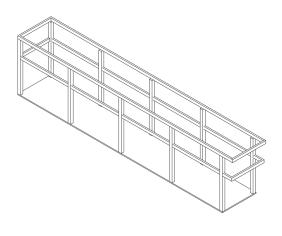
Axonometría estructural tipo 2_2 Fuente: Autores, 2024
